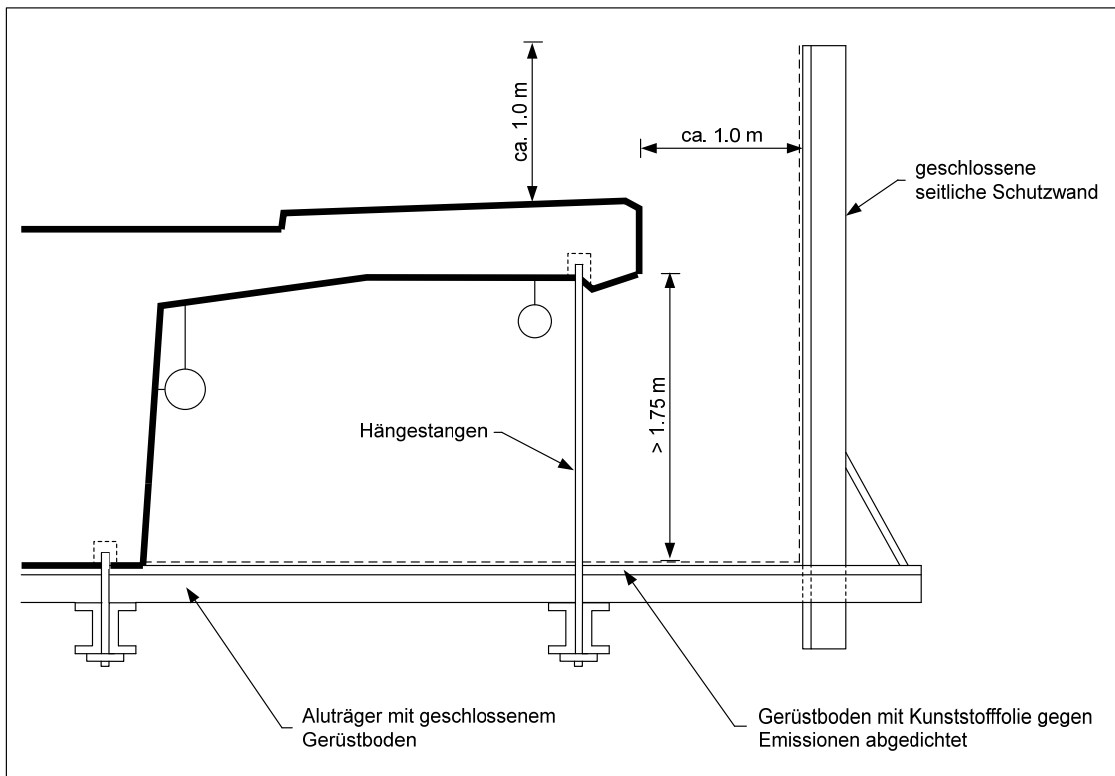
Kragarmgerüst: Hängegerüst mit Emissionsschutz
